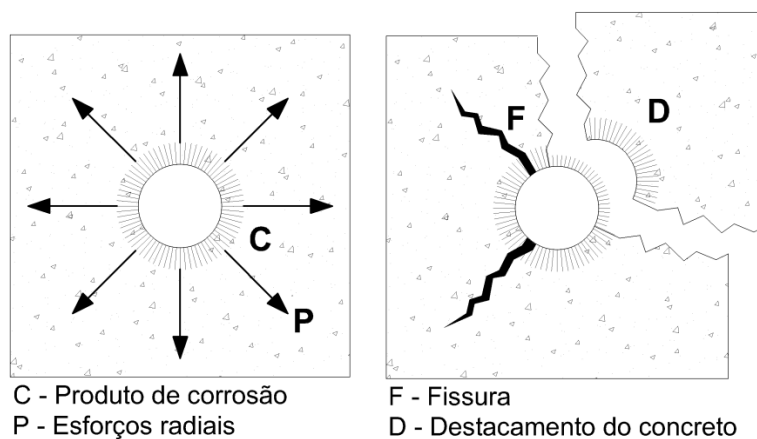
Esforços produzidos que levam à fissuração e destacamento do concreto, devidos à corrosão de armaduras
